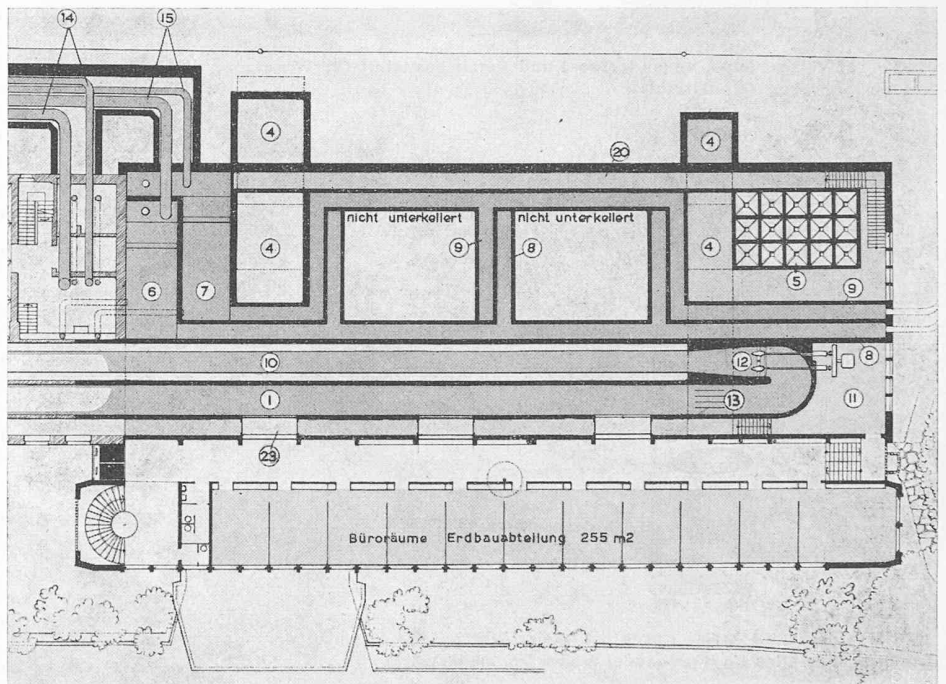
Kanalgeschoss (484,80) 1 : 500. Schraffiert = bestehender Bau
